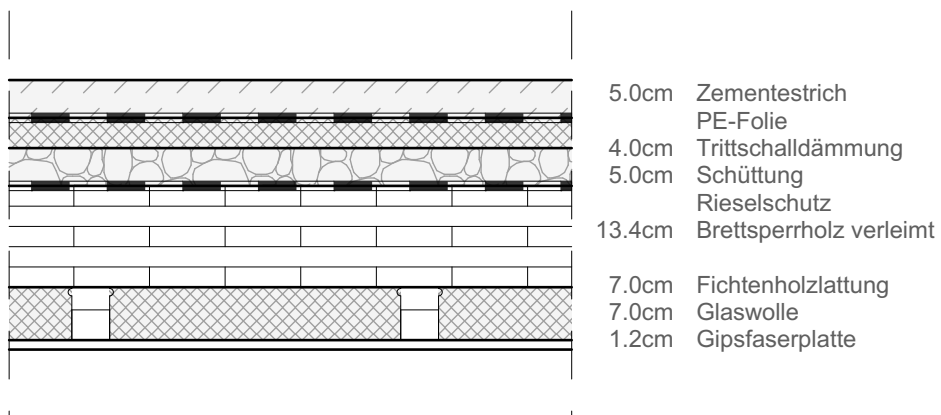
schalltechnisch vergleichbare Decke - Detail M 1:10<sup>2</sup>
